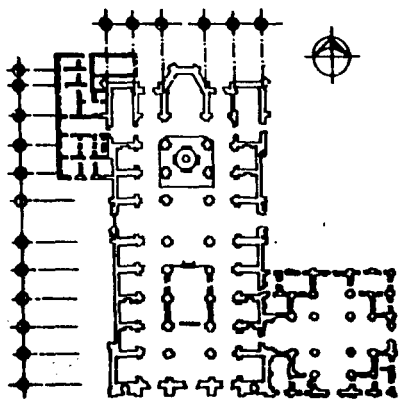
PLANTA DE CONJUNTO DE CATEDRAL METROPOLITANA.
